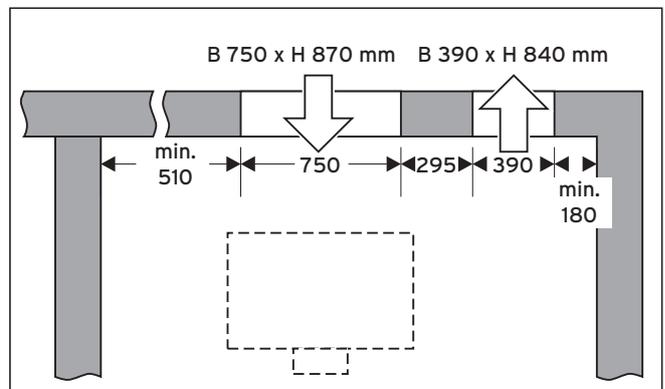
Vegginstallasjon, luftuttak til høyre
